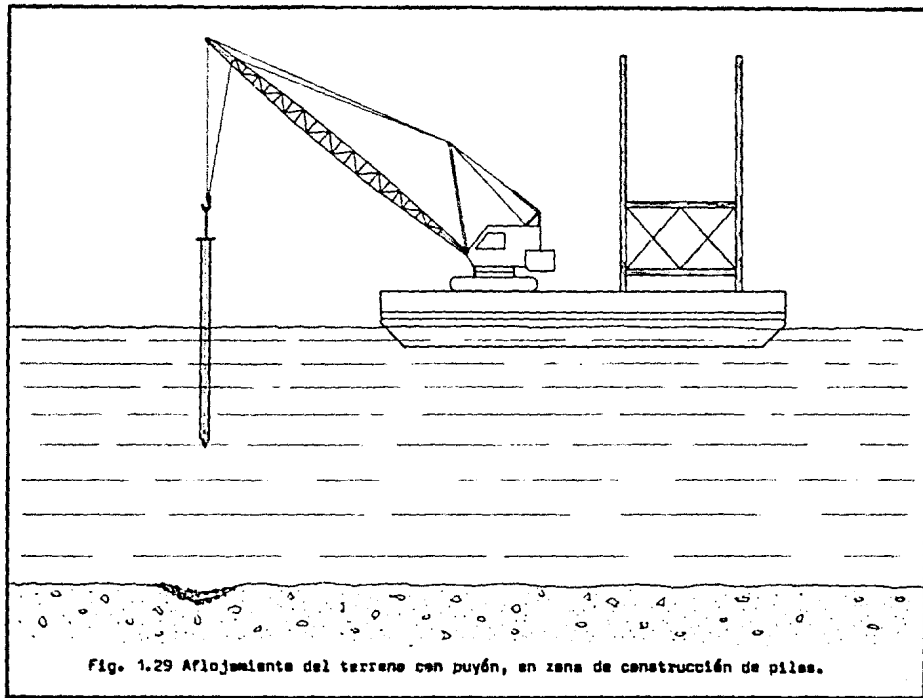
Aflojamiento del terreno con puyón, en zona de construcción de pilas.
